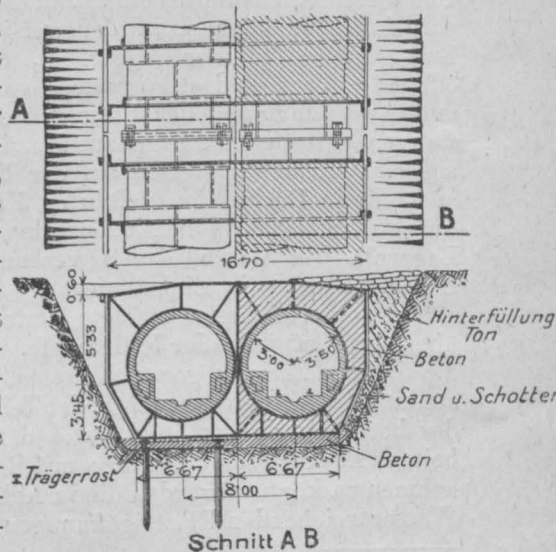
Grundriß und Querschnitte der Teilstücke (Detroitflußtunnel).
